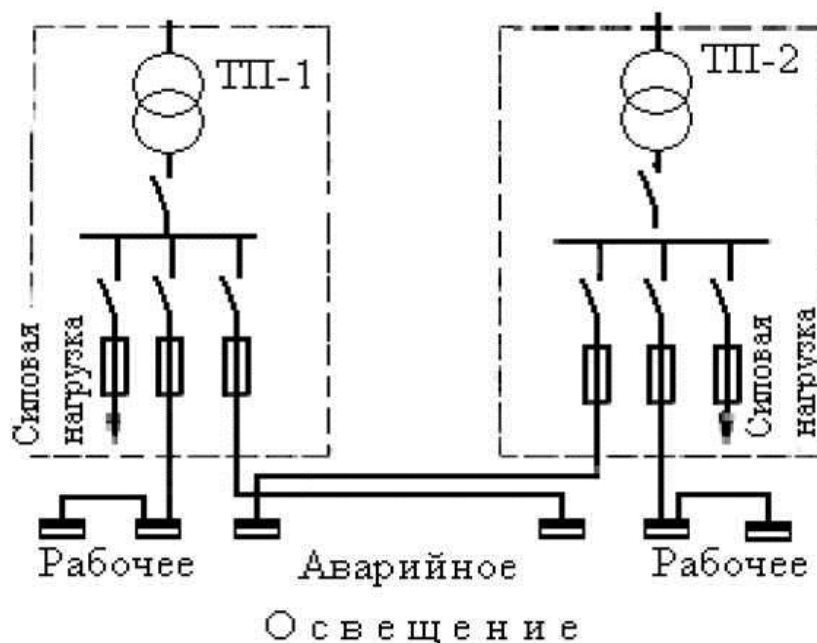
Схема совместного питания силовой и осветительной нагрузок от двух подстанций (ТП-1, ТП-2)
